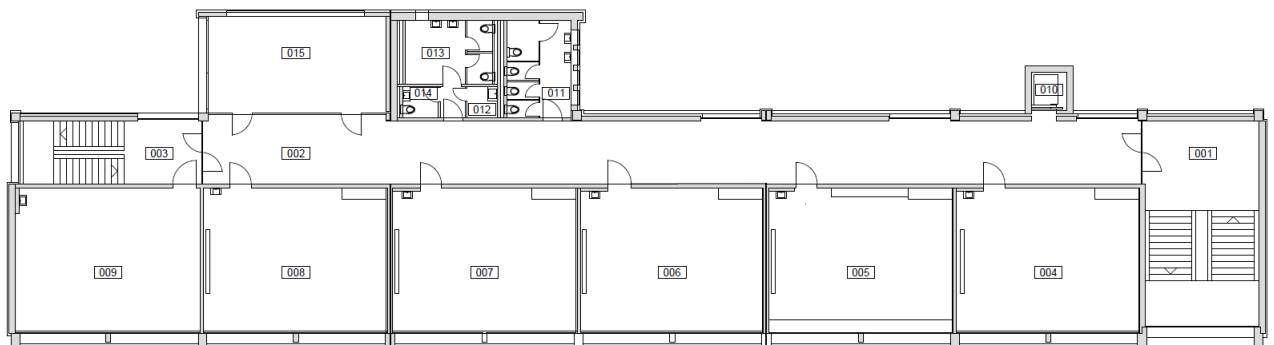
Klassentrakt H2 – 2. Obergeschoss IST
